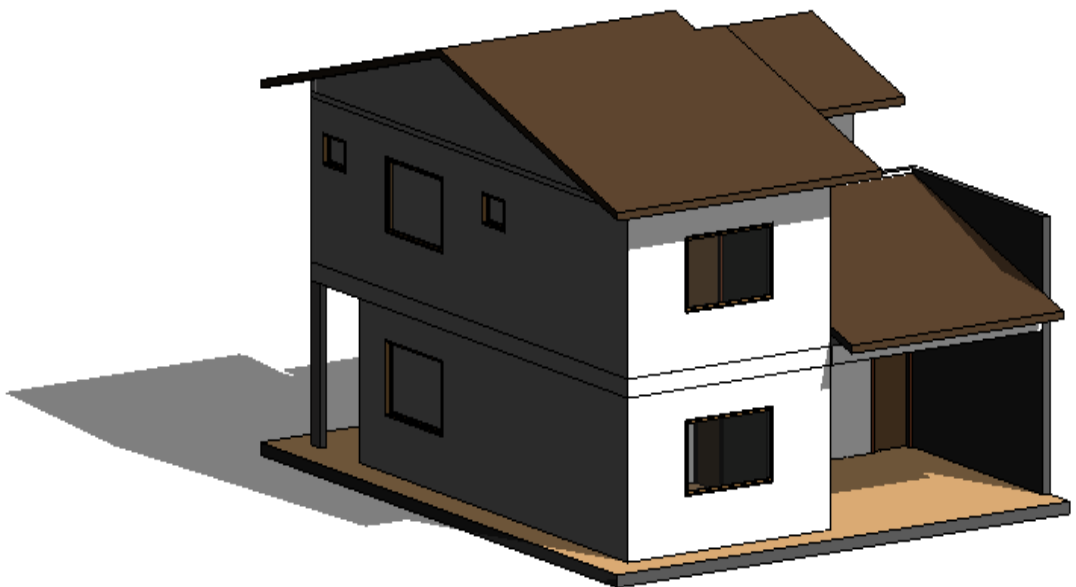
Modelo tridimensional da elevação frontal e vista lateral esquerda.
